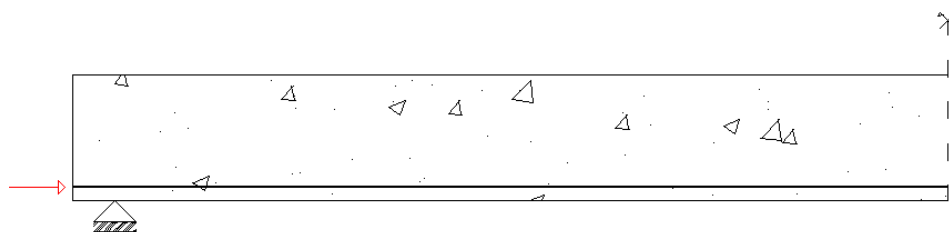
Vista lateral da viga de betão armado pré-esforçado com um tirante longitudinal reto e respetiva força pontual.
